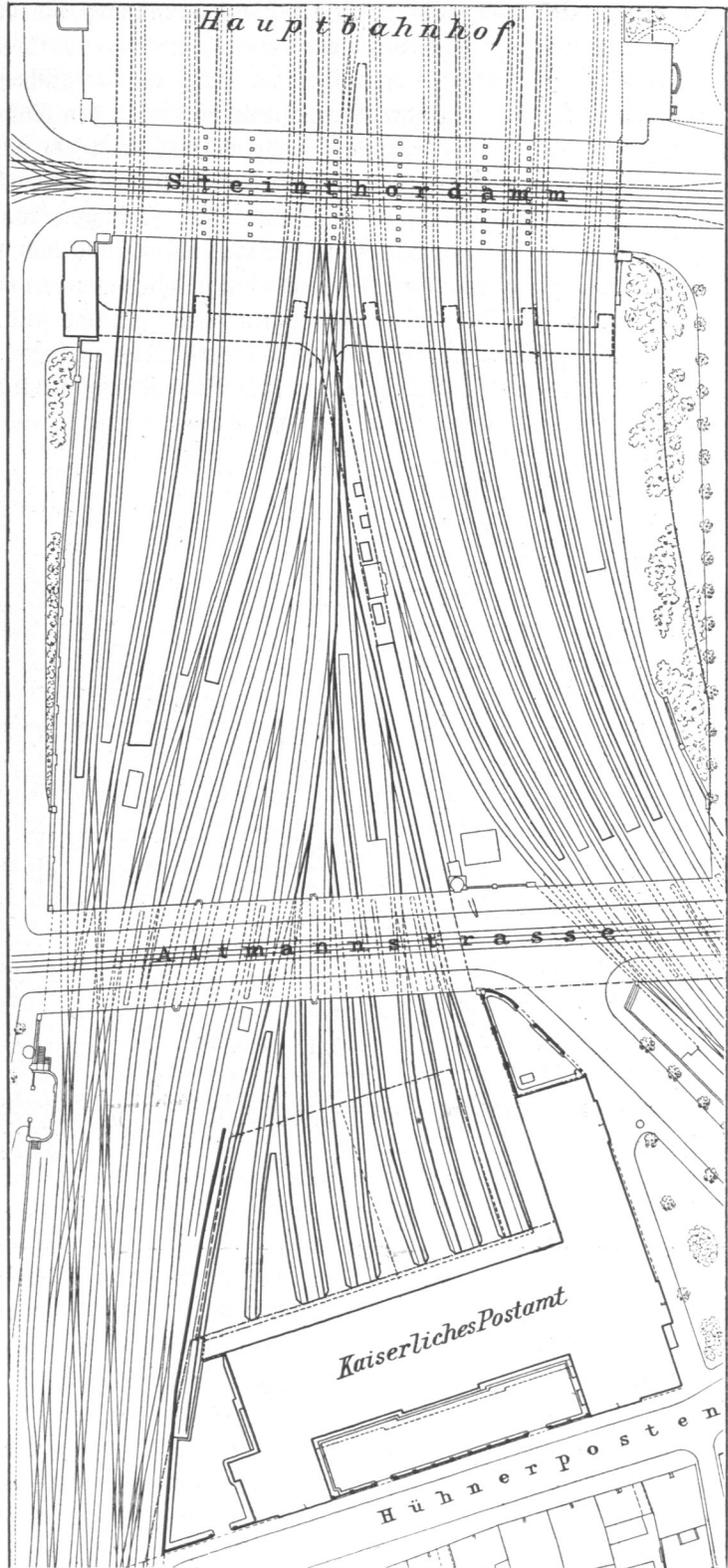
Postgebäude am Hauptbahnhof, Lageplan.
